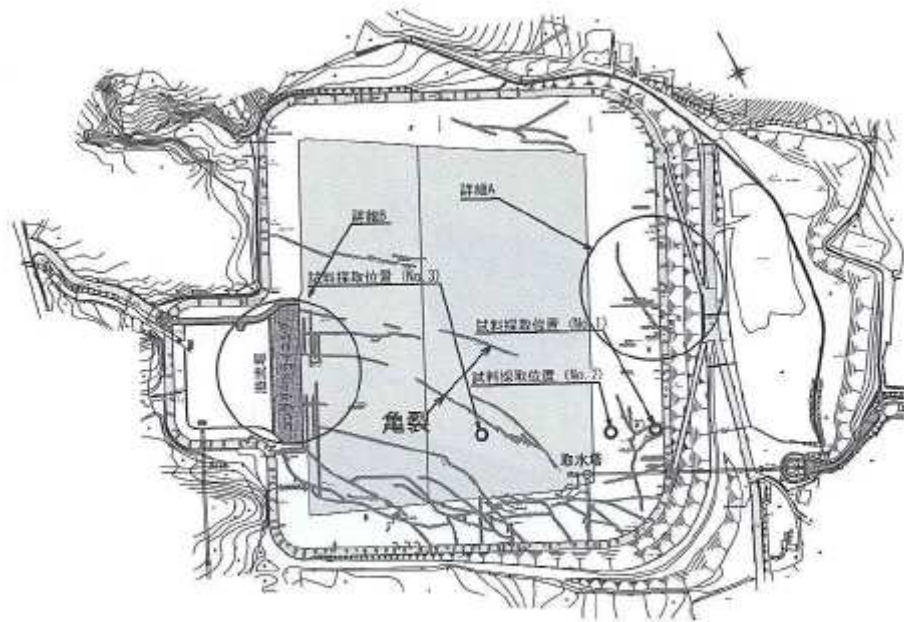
貯水池計画平面図および亀裂分布図 42)
